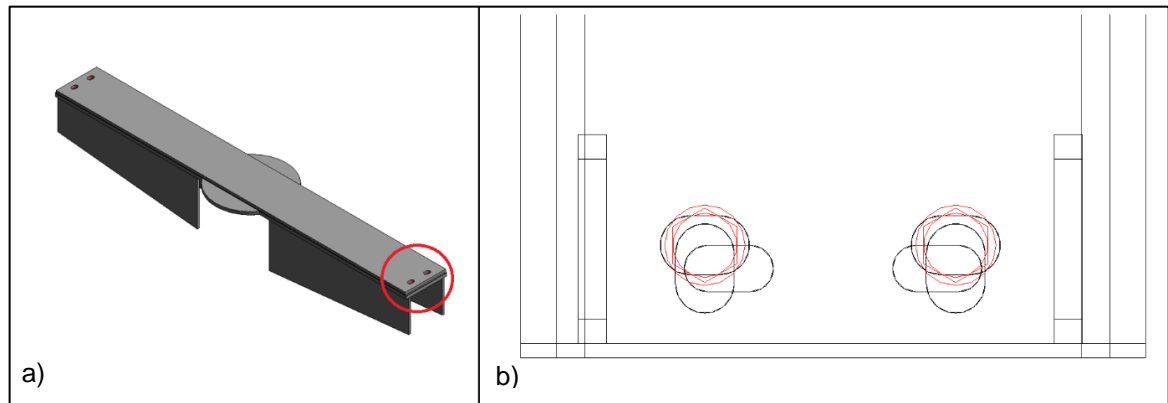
a) Vista geral do cachorro; b) Pormenor da sobreposição das chapas
